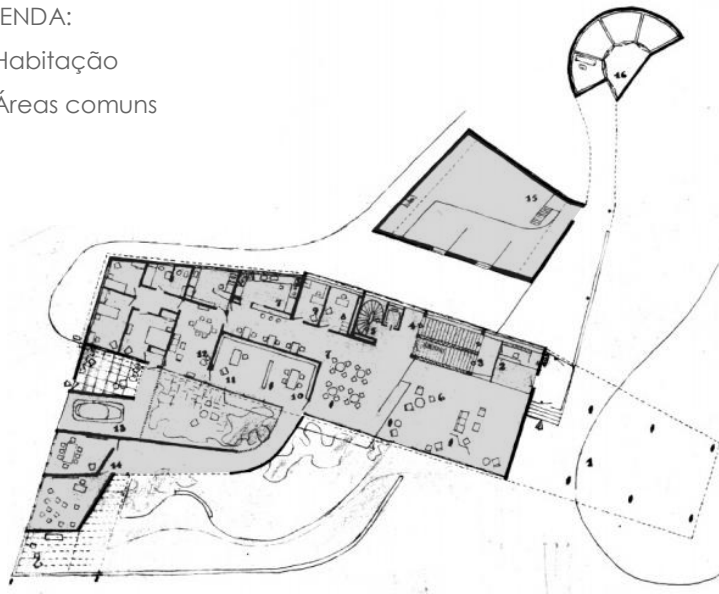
Planta pavimento térreo | Fonte: maisondubresil.org
